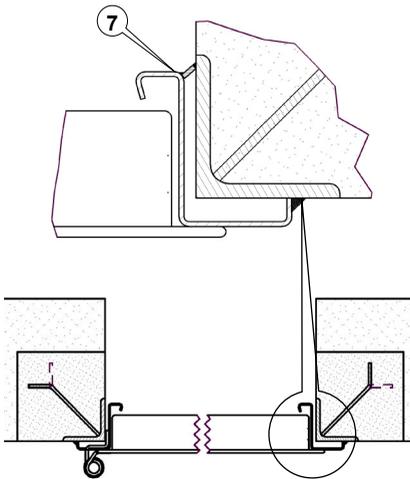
Türelement an Maueranker angeschweißt (Mauerwerk- und Betonwand)
